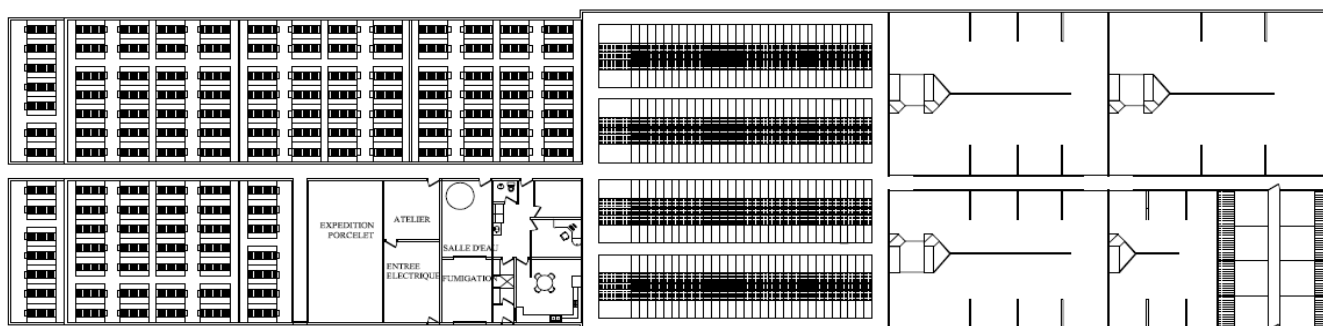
Plan de la maternité de 600 truies en groupe avec DAC
